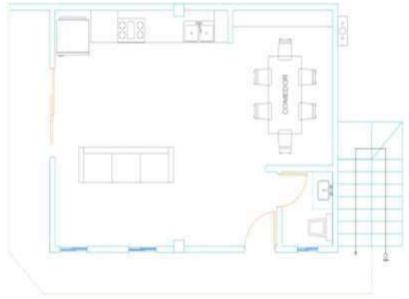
Planta Arquitectónico P/B Fuente: Elaborado por el autor
